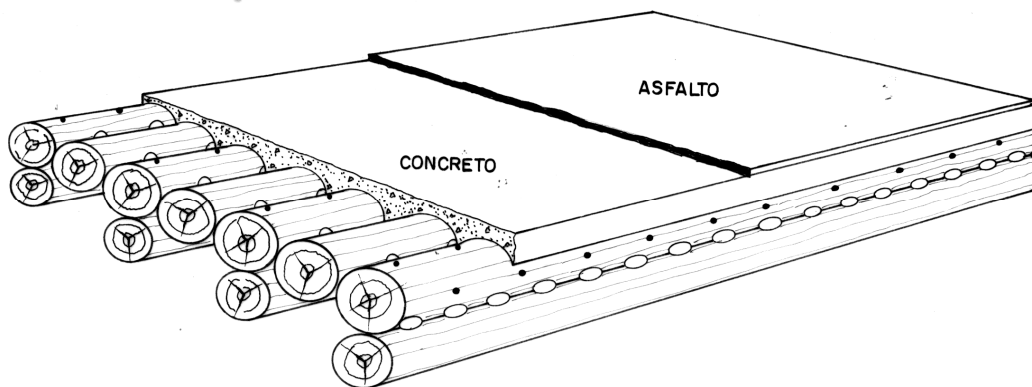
Proposta para construção da ponte de postes de madeira solidarizada por uma camada de concreto e asfalto. Fonte: MATTHIESEN (1987)
